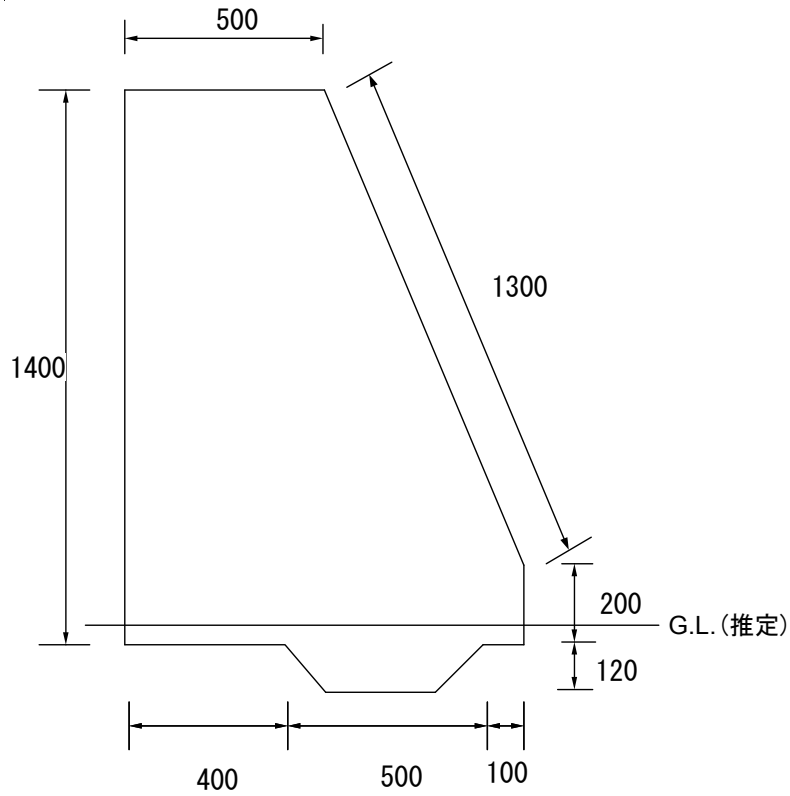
転倒した堤防断面図 (単位 : mm)
